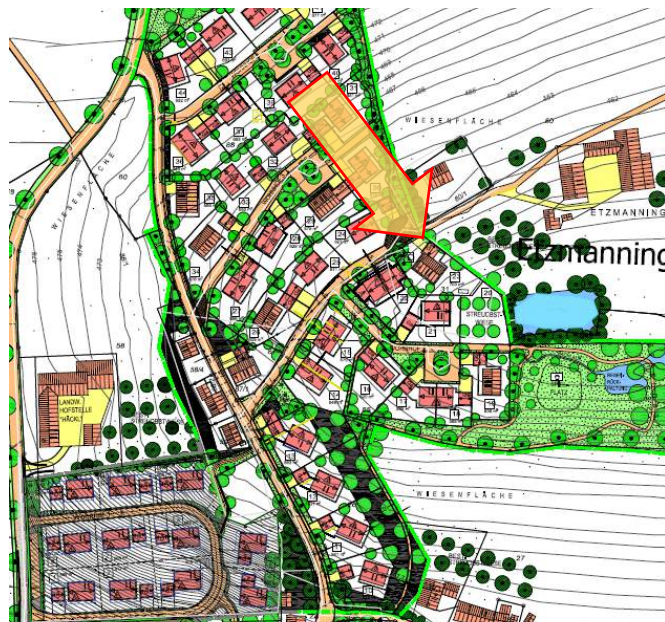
Lage Schadensort Blasiusstraße 20 (gelber Pfeil)
